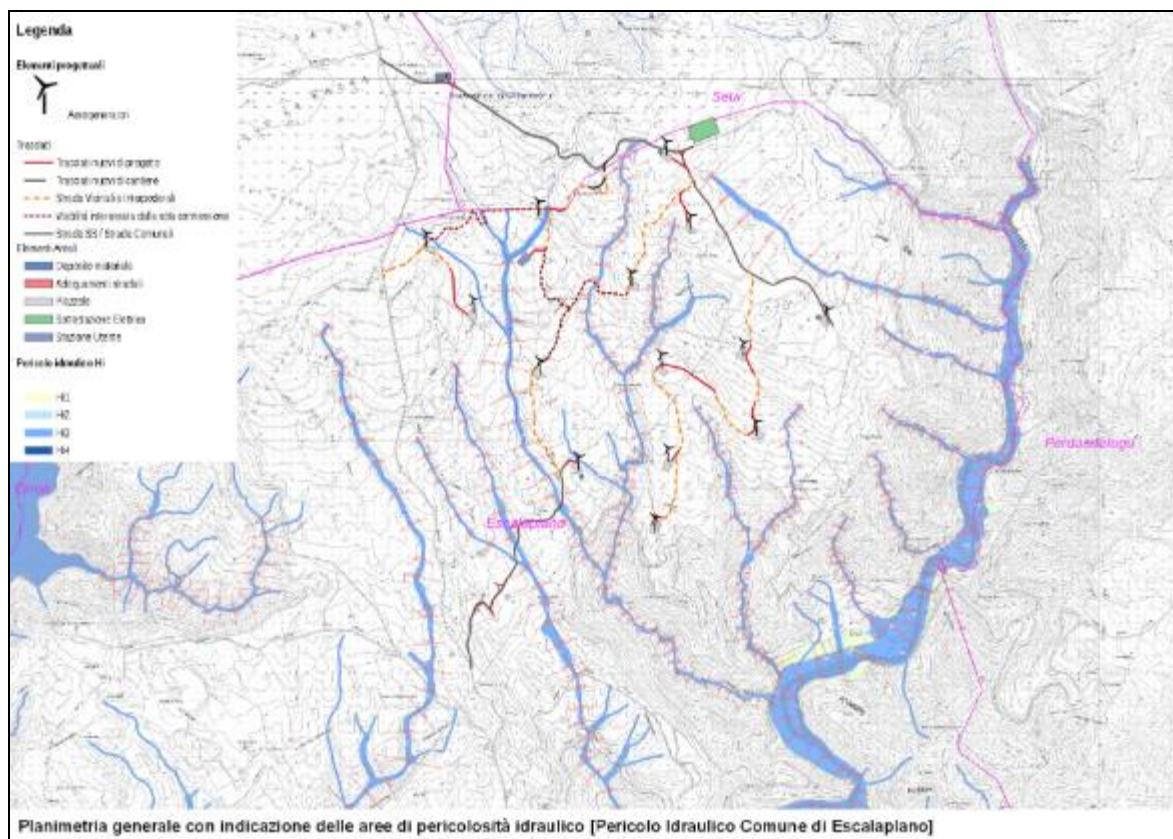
Planimetria generale con indicazione delle aree allagabili secondo la Variante PAI del Comune di Escalaplano.
